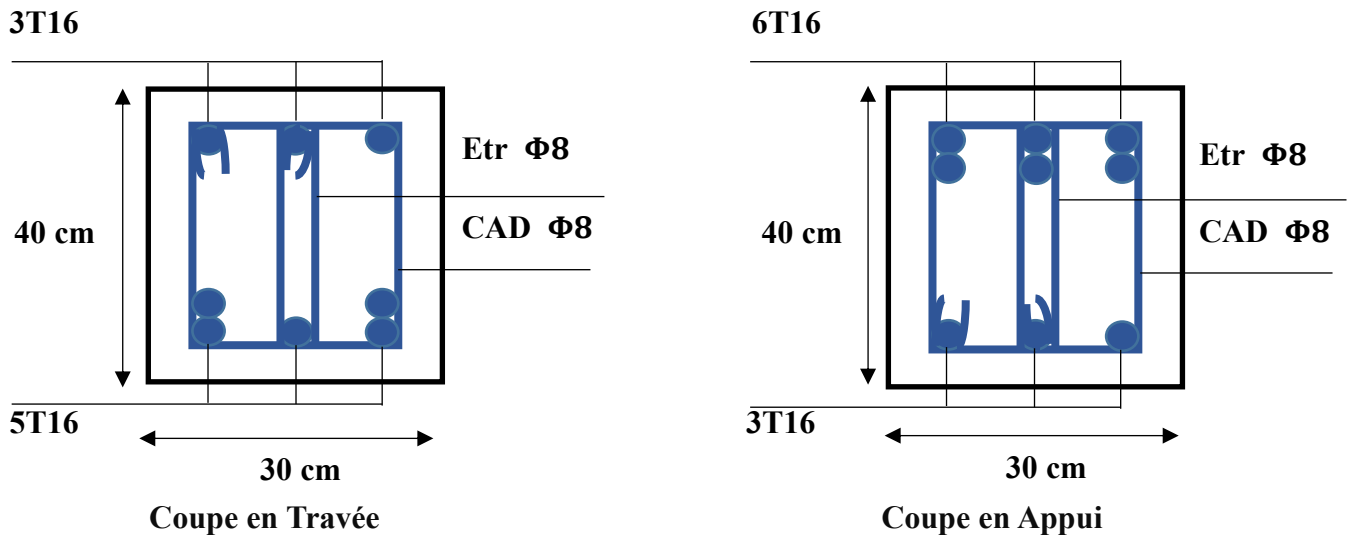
dispositions du ferrailage longitudinal du poutre principal
